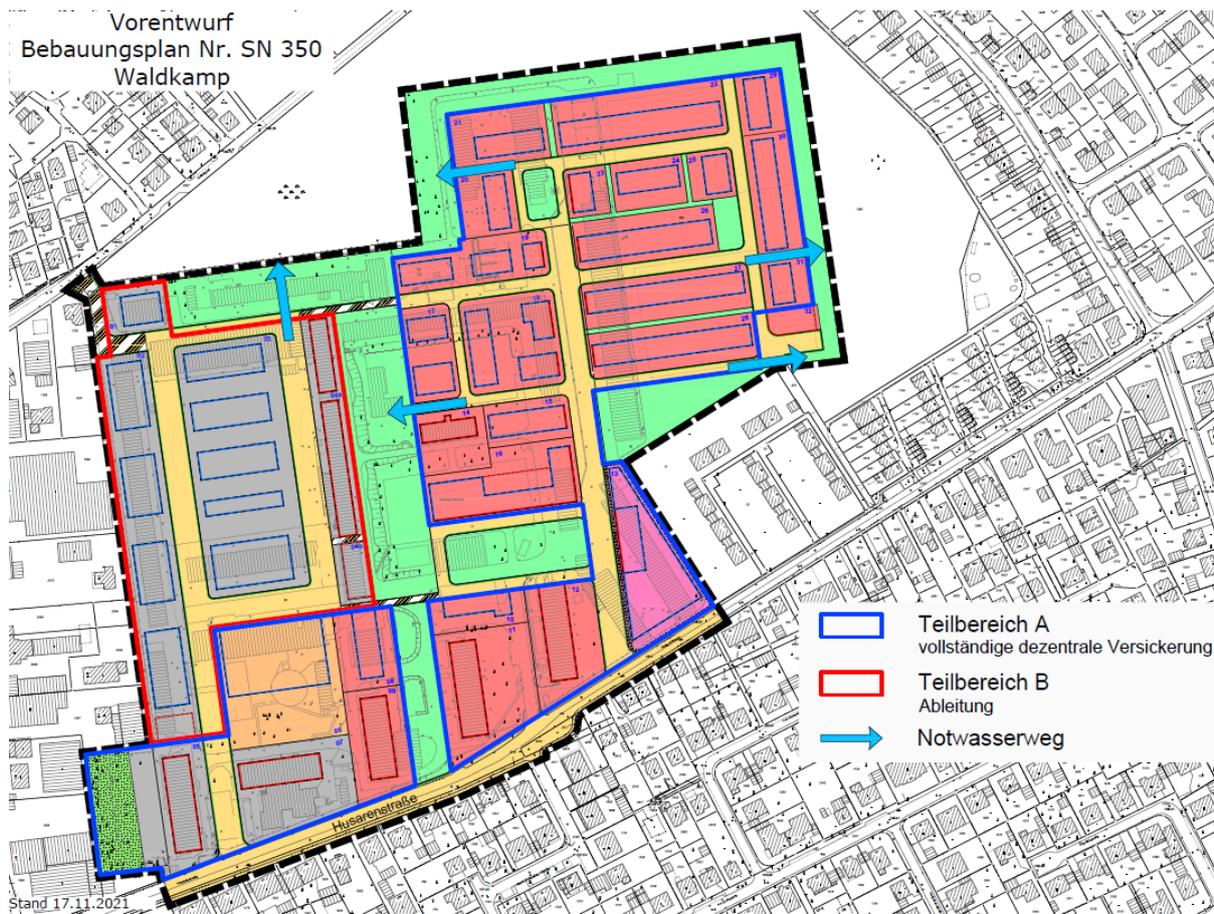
Vorentwurf Bebauungsplan mit Entwässerungsbereichen A und B
